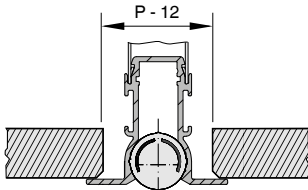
Einbau in geschlossene Decke (mit Randverbreiterung), Länge Einbauöffnung mit Endwinkel: $L1 + 7$
